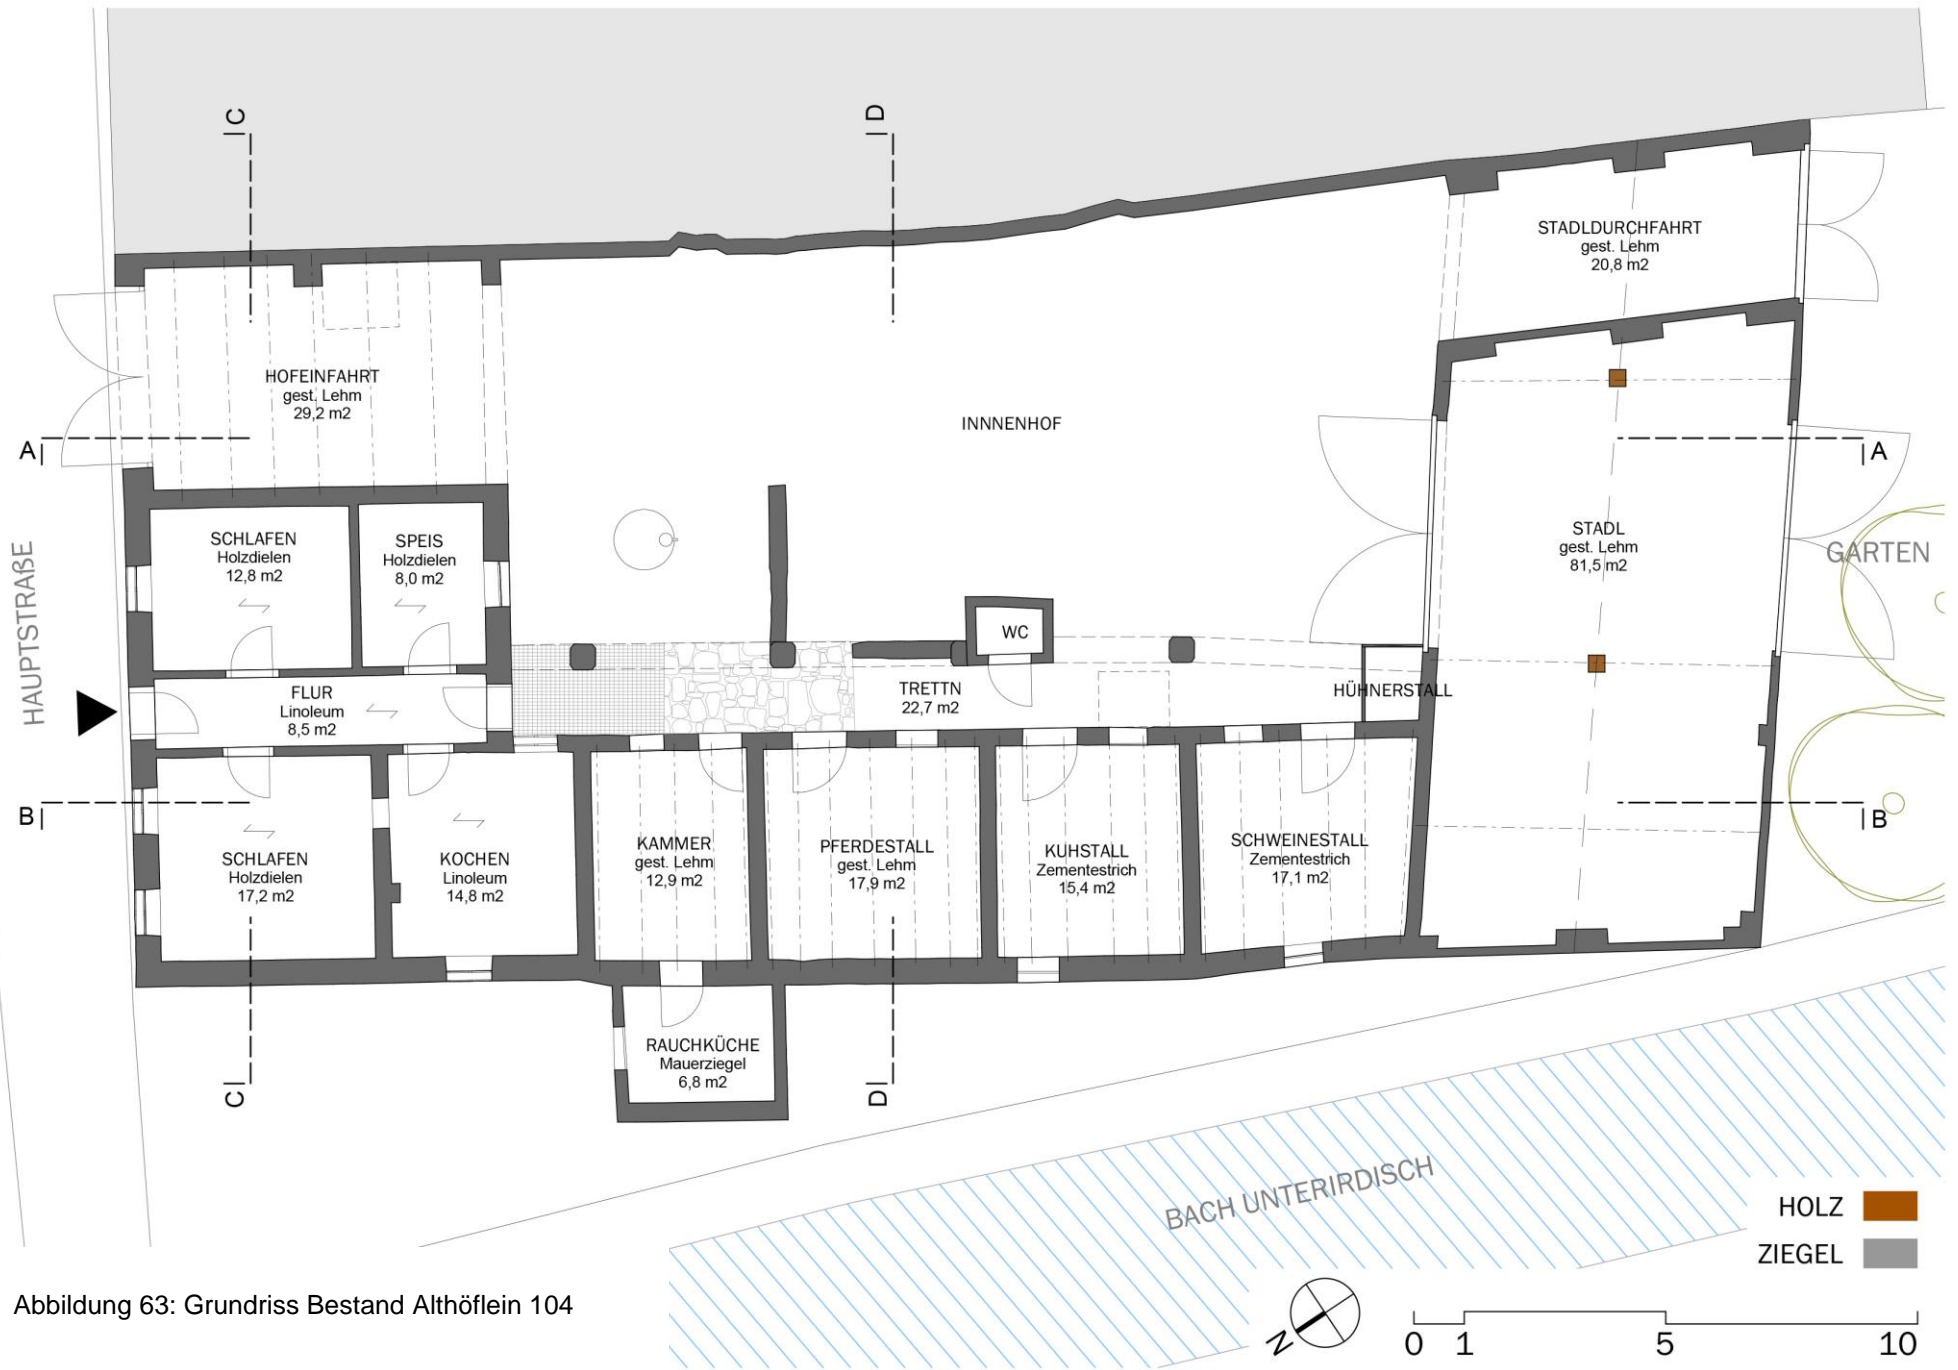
Grundriss Bestand Althöflein 104
